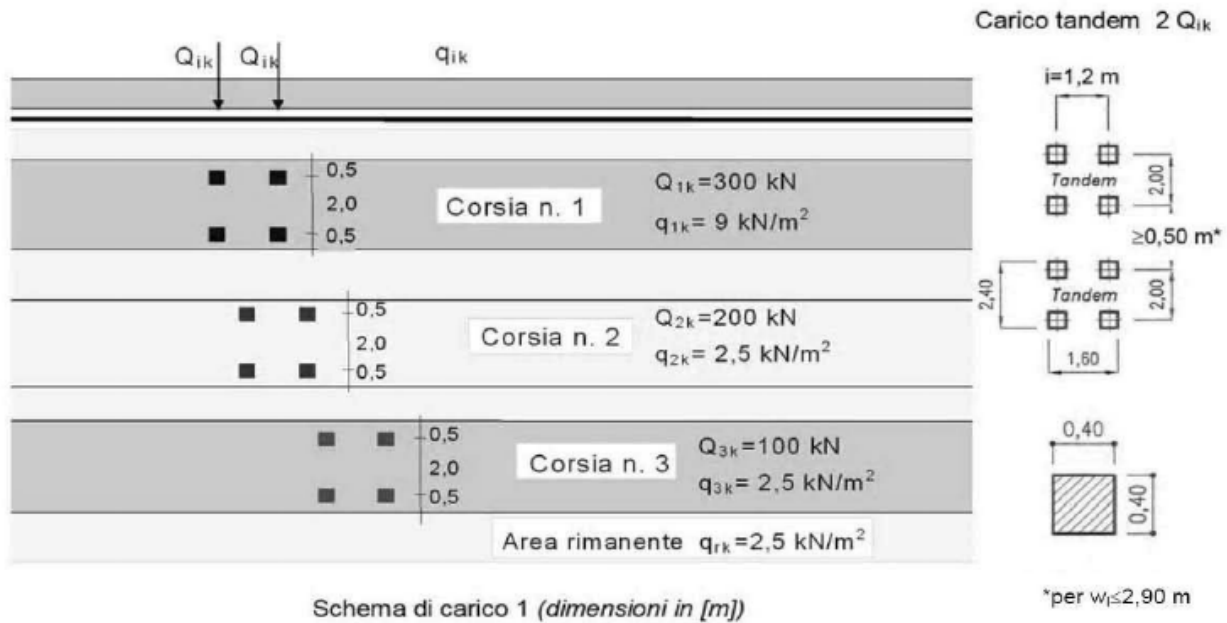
Schema di carico 1, estratto dalla Fig. 5.1.2
